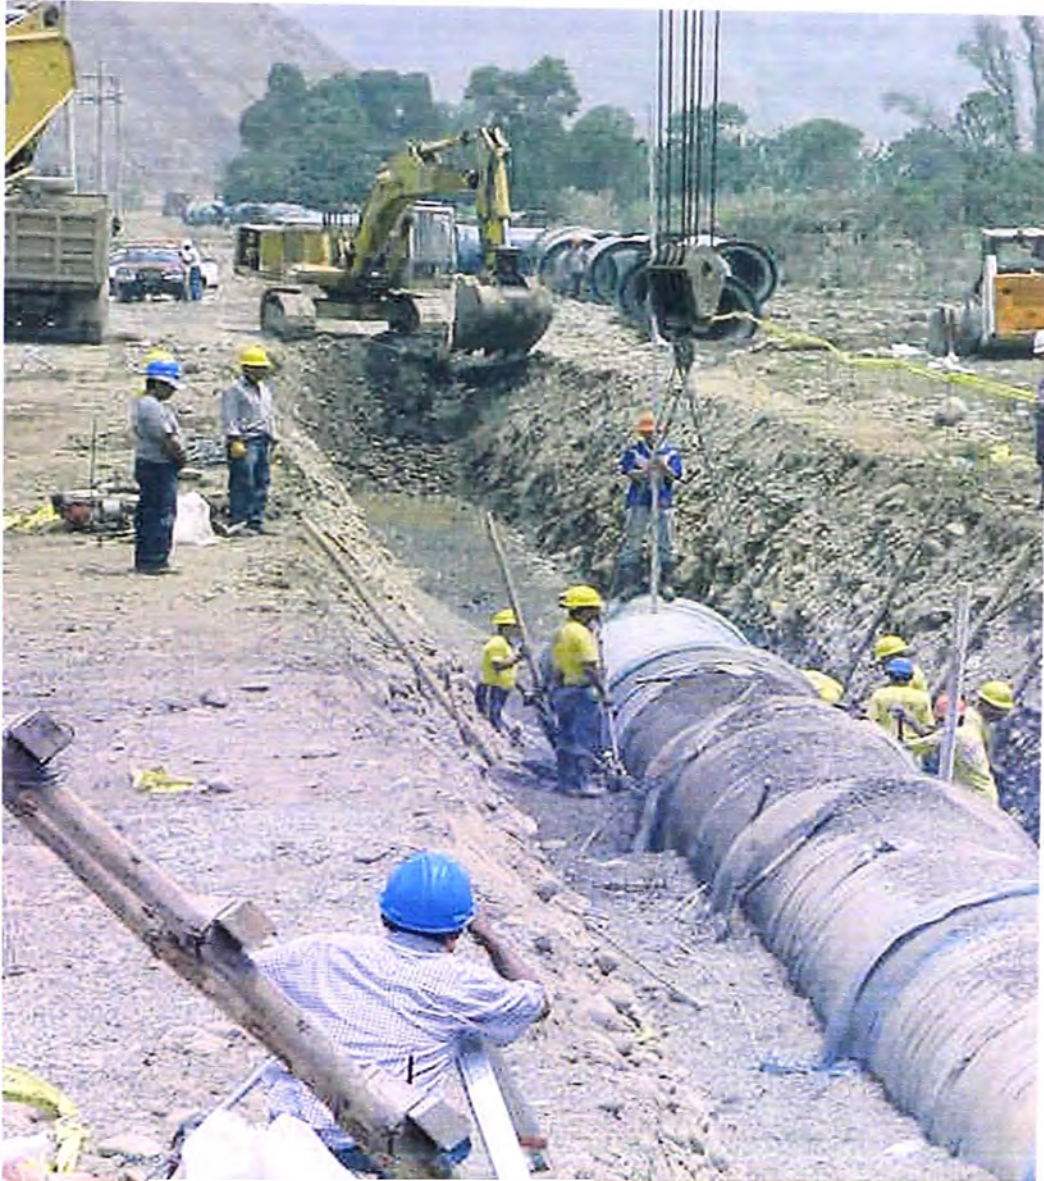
Línea de conducción, desde la bocatoma al reservorio de compensación, con tuberías de concreto armado CAP de diámetro de 1400 mm.
